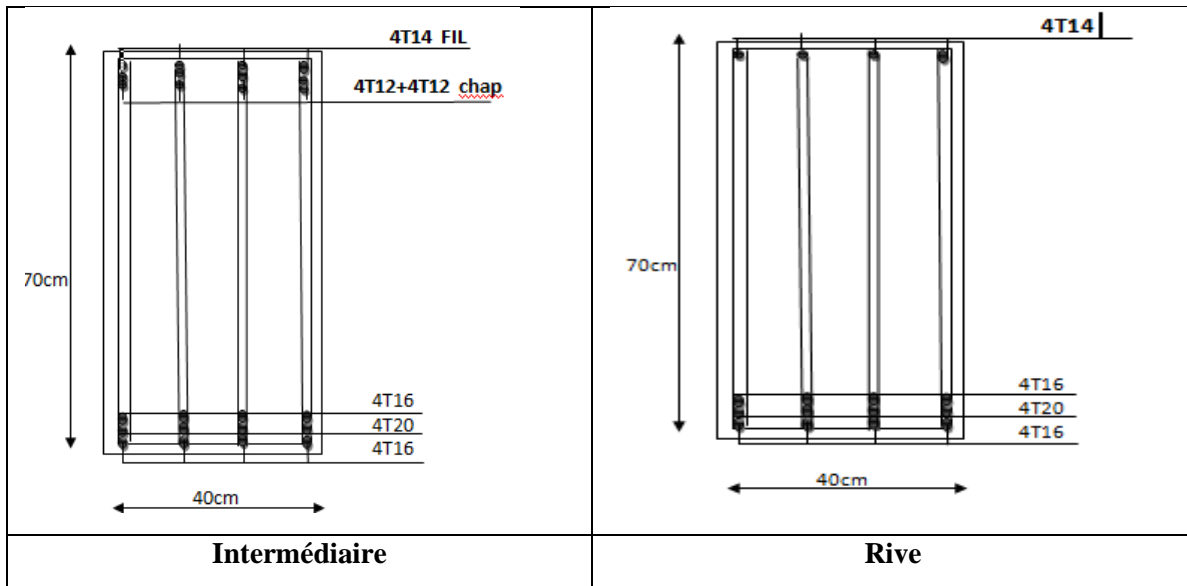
Ferrailage de la poutre de libage suivant le sens longitudinale
